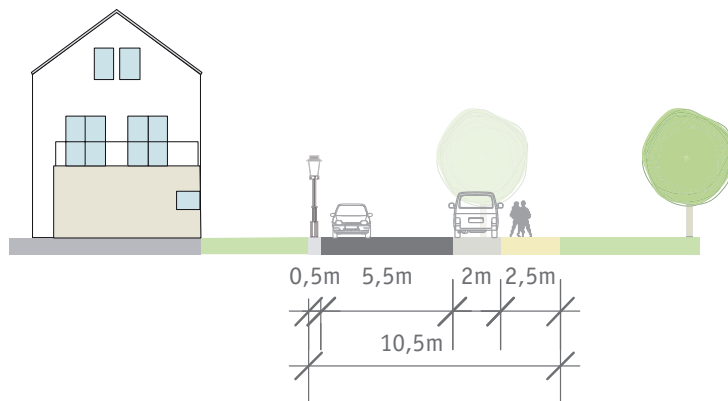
Prinzipschnitt Wohnstraße mit Gehweg und Park-/Grünstreifen
